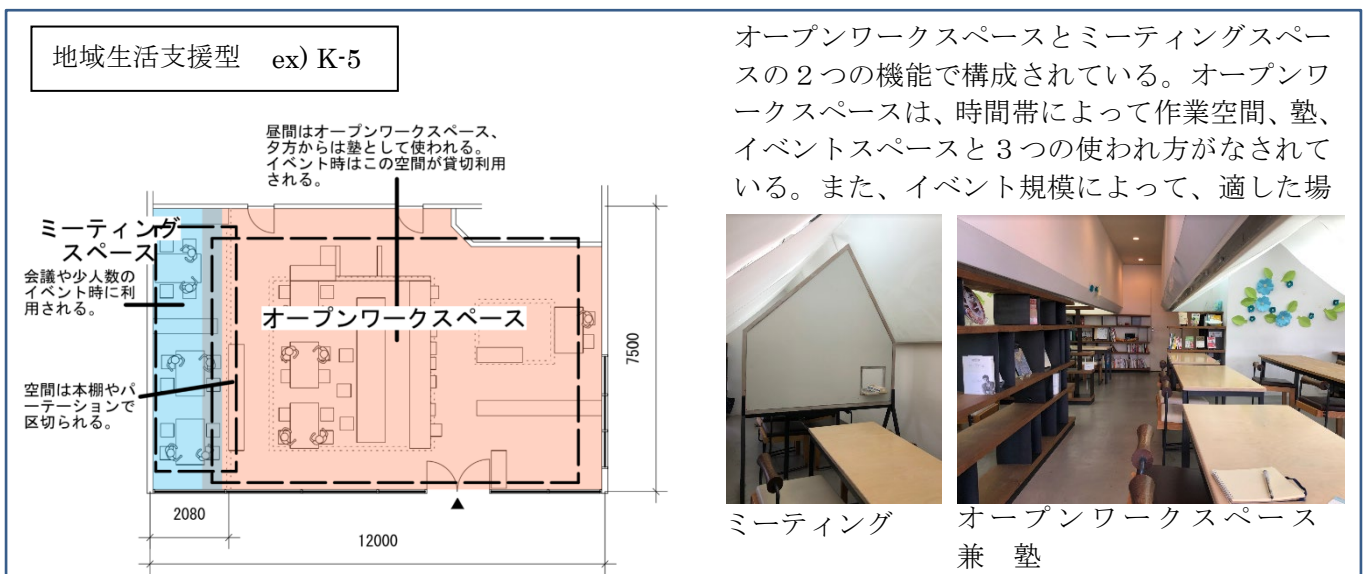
地域生活支援型における機能（事例 K-5 平面図・写真）
